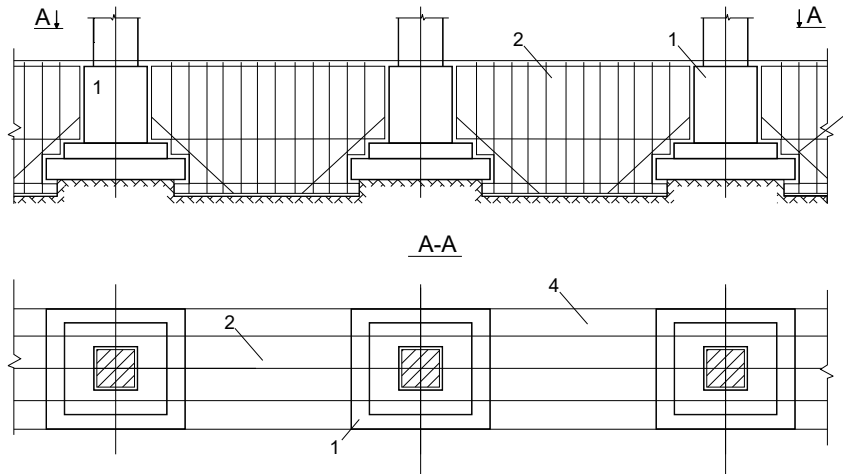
Схема перебудови стовпчастих фундаментів у стрічкові
